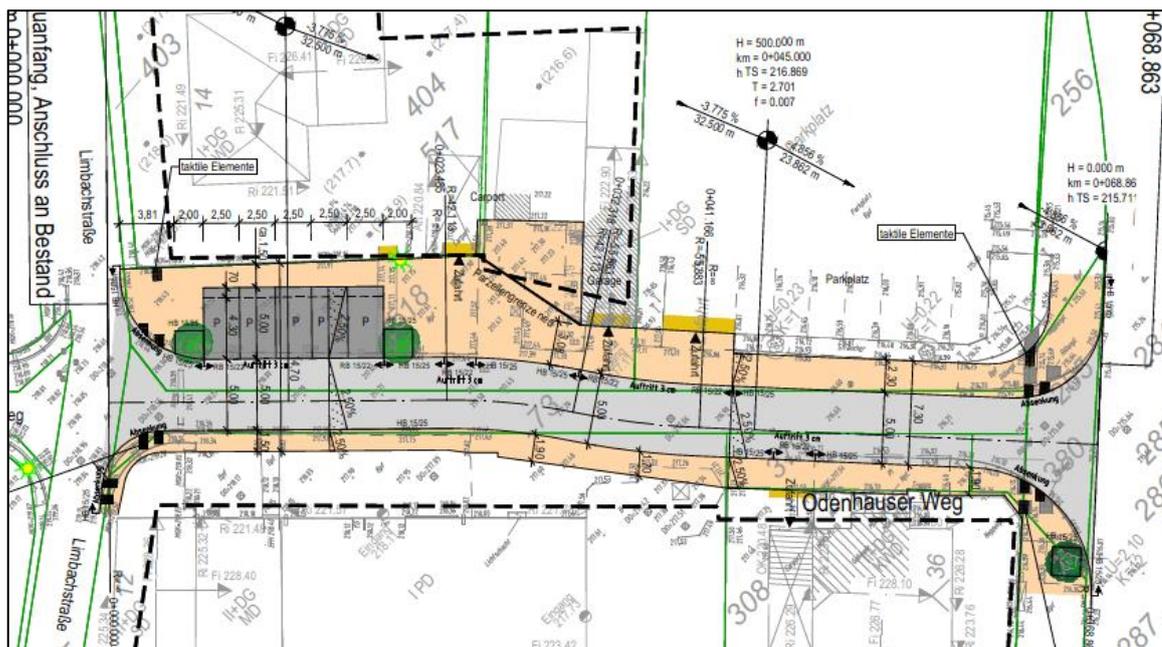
Vorplanung Umgestaltung Teilbereich Odenhauser Weg, Lageplan Variante 2 – Vorabzug März 2022
